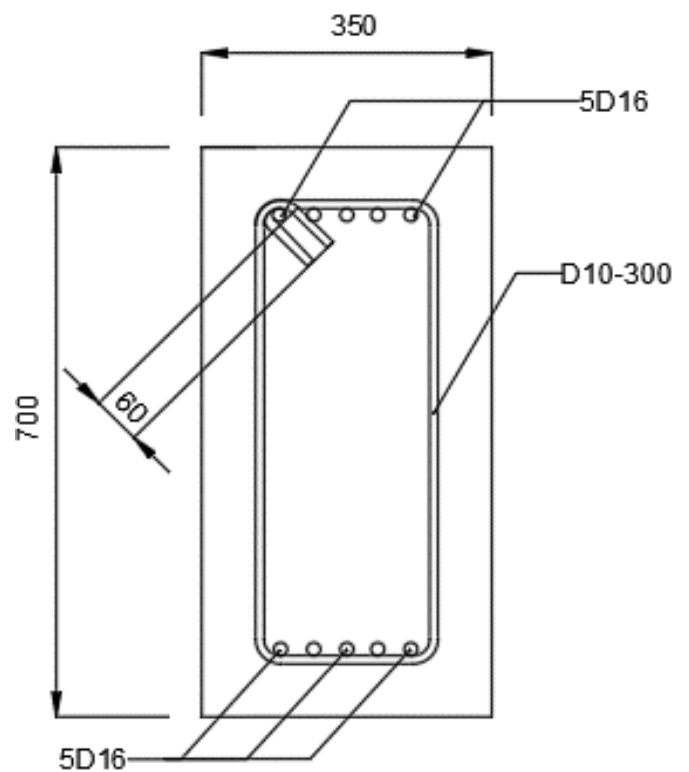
Desain Penulangan Balok Tipe -1 (Balok Crane) Keterangan : Satuan dalam mm
